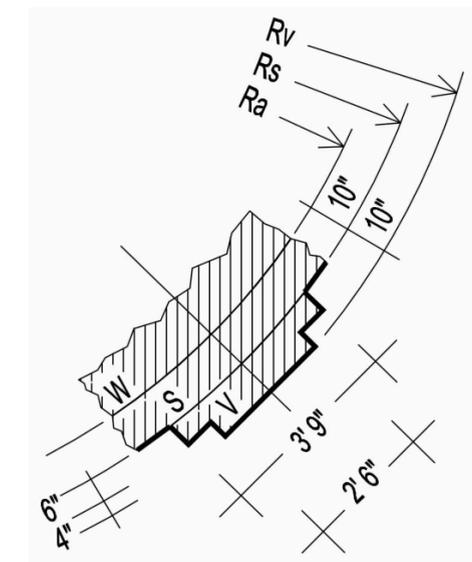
Pfarrkirche Schöngrabern, Apsis (Basis der Pfeilervorlagen mit kotiertem Grundriss)
